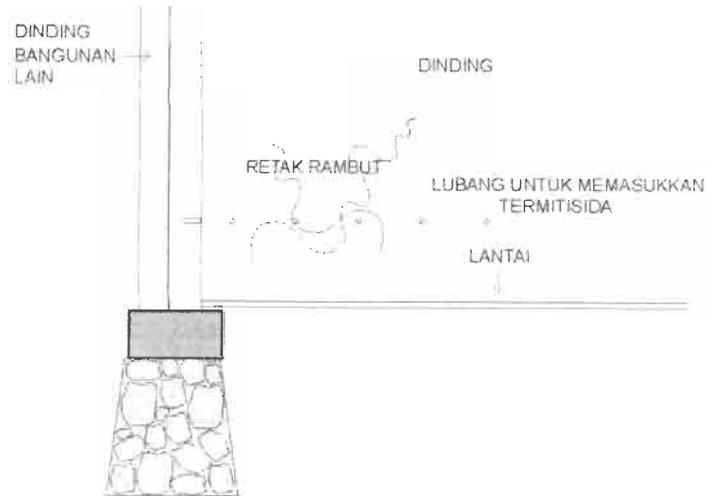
Pengeboran lantai sepanjang pondasi
